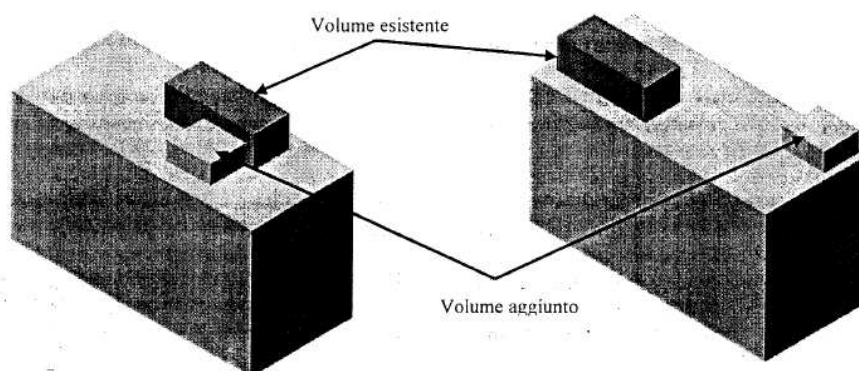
Esempi di addizioni volumetriche su coperture piane
